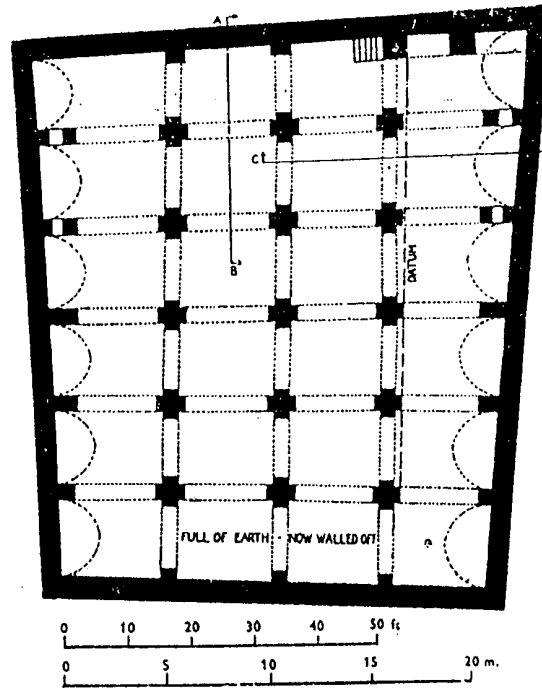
مسقط أفقي لمسجد قصر الحلابات
